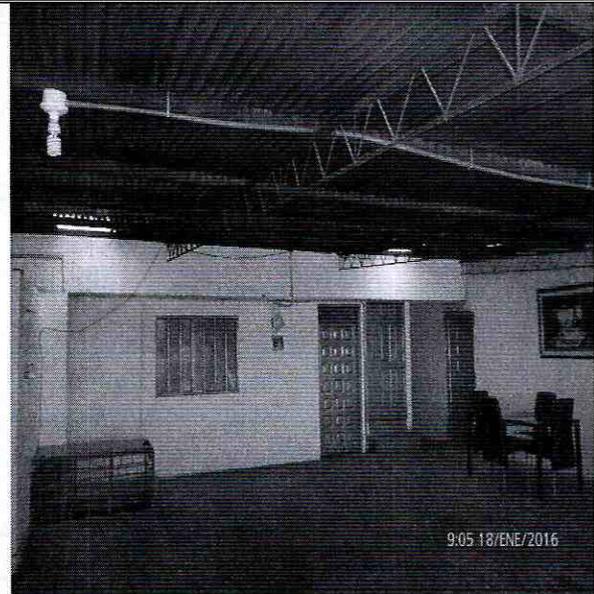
Vista de la vivienda ubicado en el predio de la Calle 29 Sur No. 4 – 95 Este, en el Barrio Catastral Santa Inés Sur II de la Localidad San Cristóbal.
